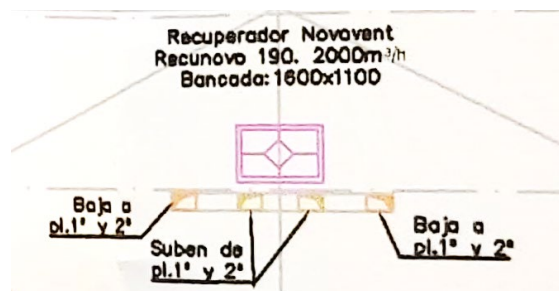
Recuperador de cubierta (aulas 16-17) y conductos de ventilación a aulas. Detalle de los planos. Fuente: Ferrovial.
